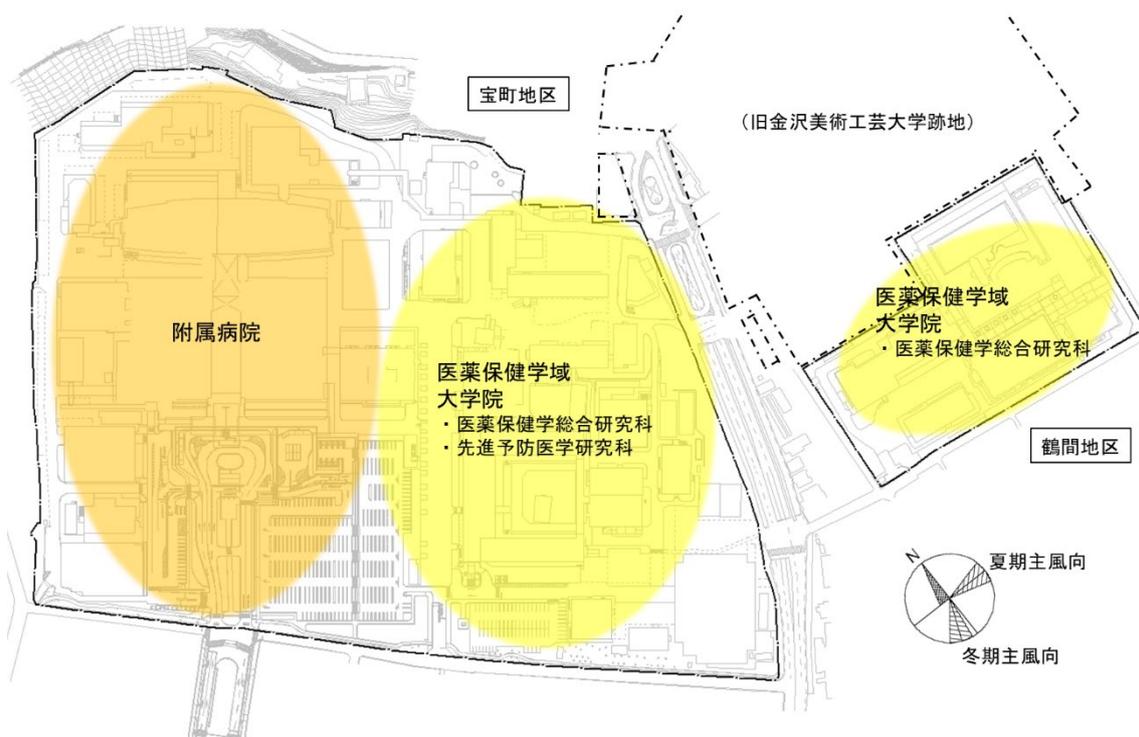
：宝町・鶴間キャンパスの施設配置図
